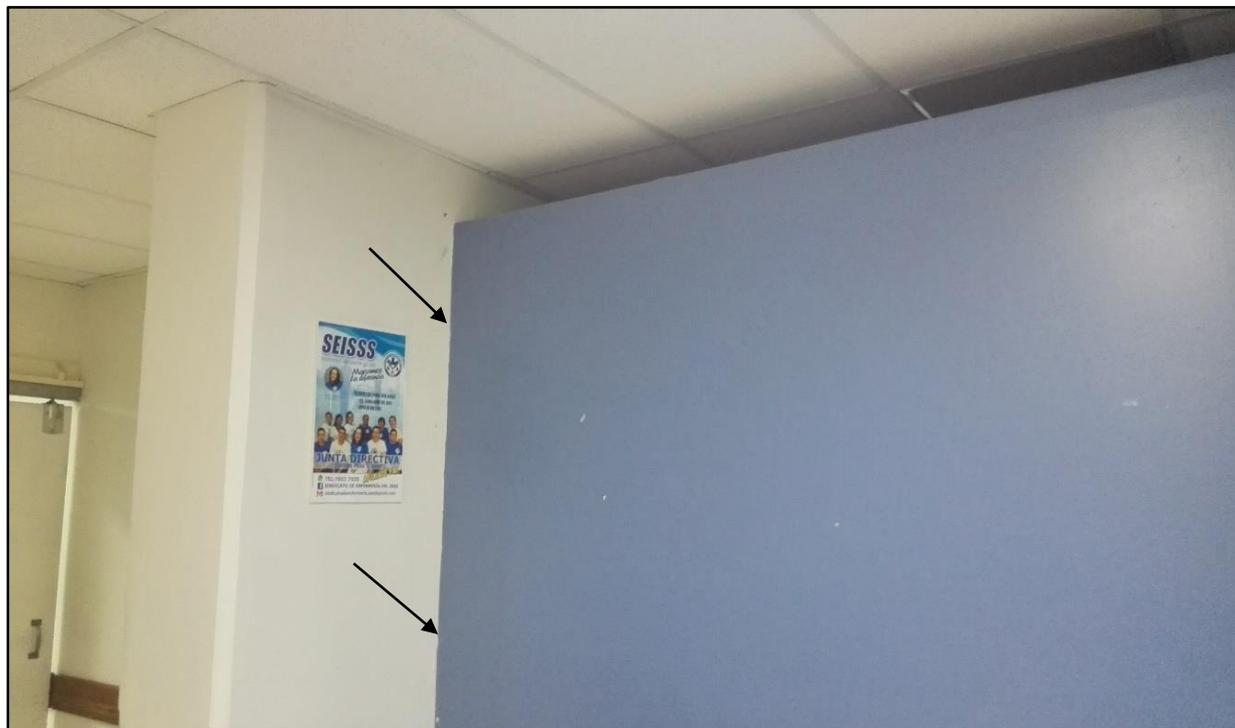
En color azul pared divisoria de mampostería de block sin interacción directa con la columna debido a una junta de dilatación.
